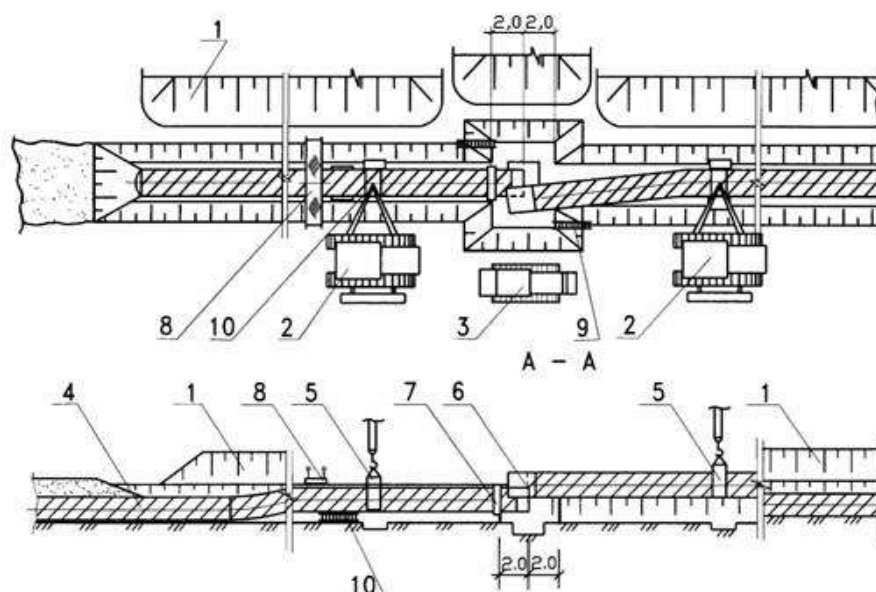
Схема производства работ при монтаже и сварке трубопровода:
